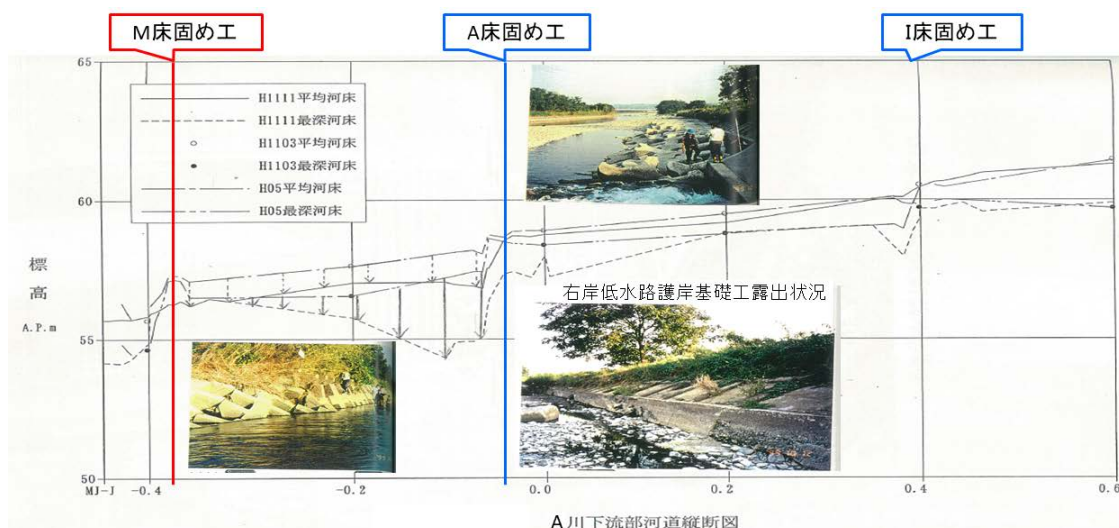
M床固め工上流河道被災前後河床高縦断図
